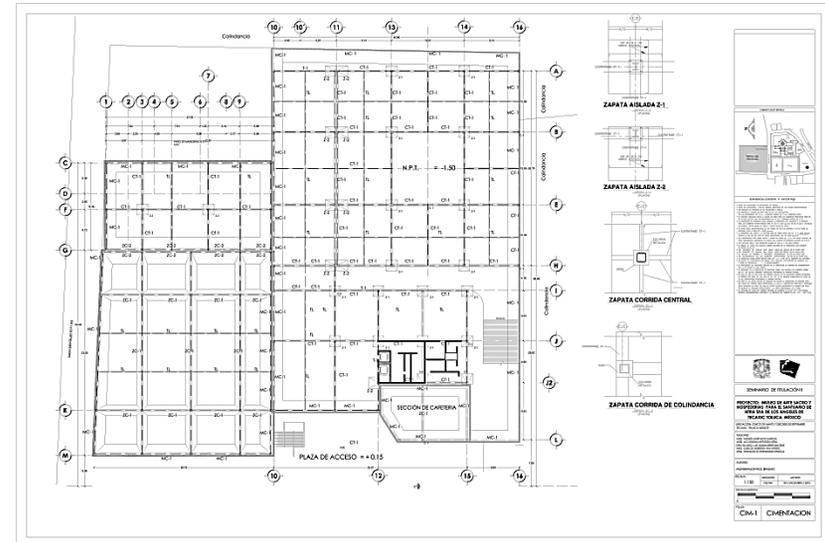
, 58 y 59. Propuesta Estructural de Museo de Arte Sacro. Planta baja y primer Nivel. Autoría Propia de Erasmo Mondragón Ruíz
